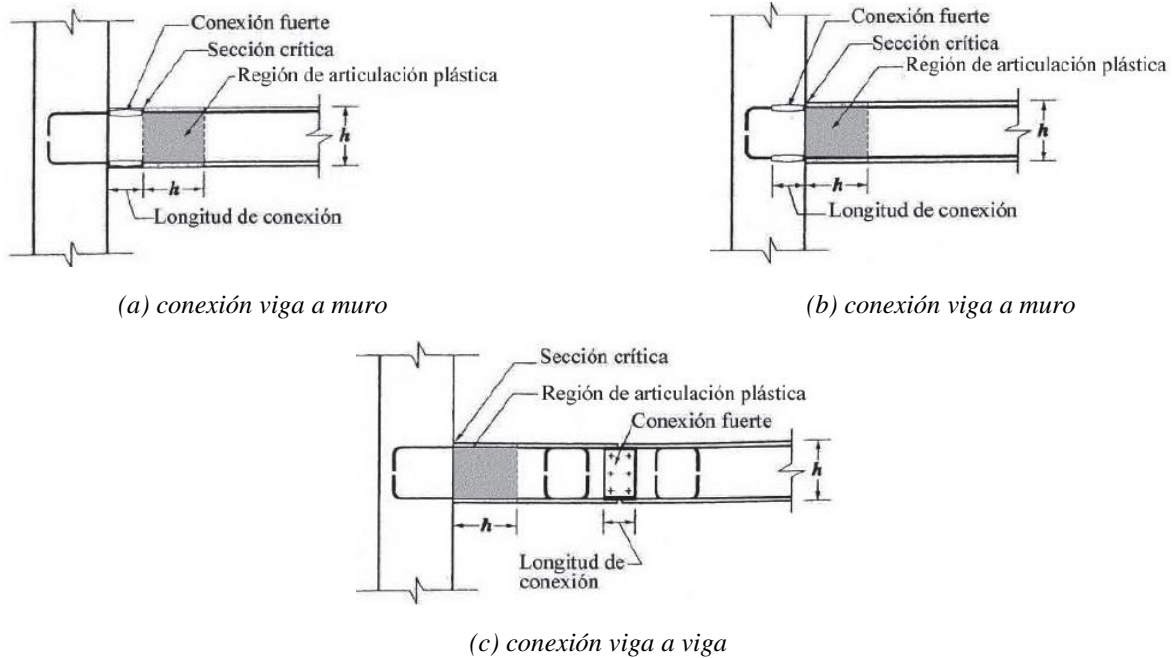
Ejemplos de conexiones fuertes en vigas ACI (2014).
